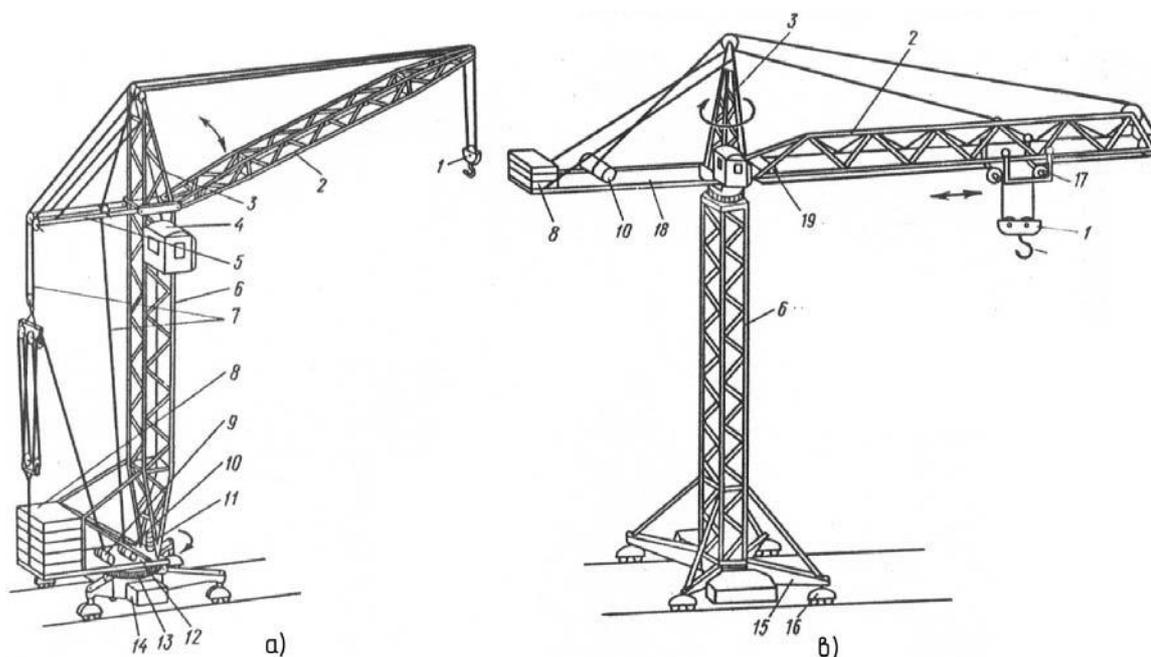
Конструктивные типы кранов: *а* – с поворотной башней и подъемной стрелой; *б* – с неповоротной башней и балочной стрелой; 1 – крюковая подвеска; 2 – стрела; 3 – оголовок; 4 – кабина; 5 – распорка; 6 – башня; 7 – канаты; 8 – противовес; 9, 10, 19 – лебедки; 11 – механизм поворота; 12 – поворотная платформа; 13 – опорно-поворотное устройство; 14 – балласт; 15 – ходовая рама; 16 – ходовая тележка; 17 – грузовая тележка (каретка); 18 – противовесная консоль
